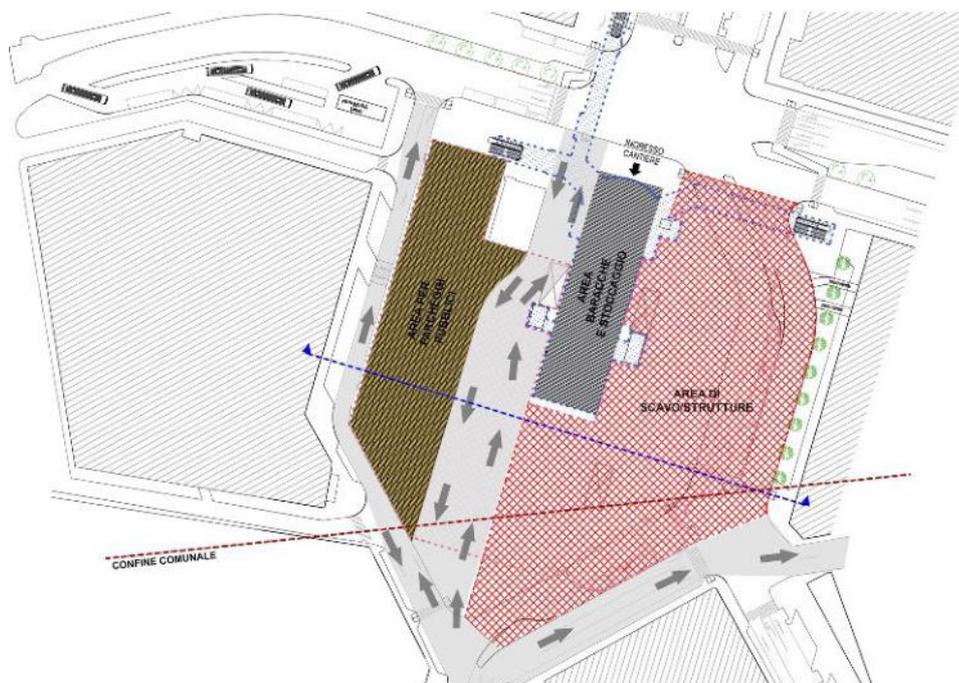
Pianta e sezione dell'organizzazione di layout per la Fase 1
